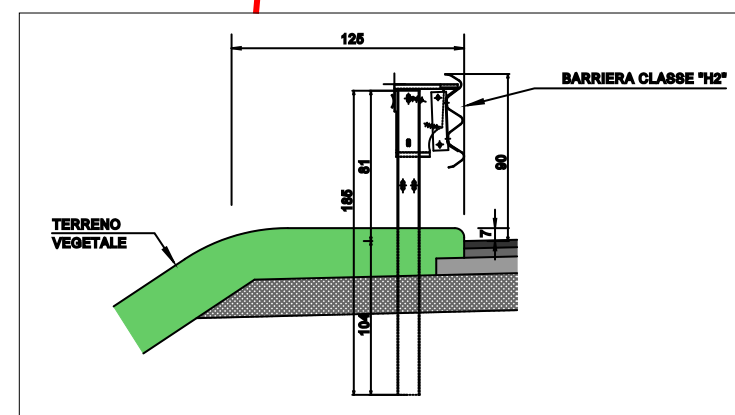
Particolare barriera tipo H2 bordo rilevato
